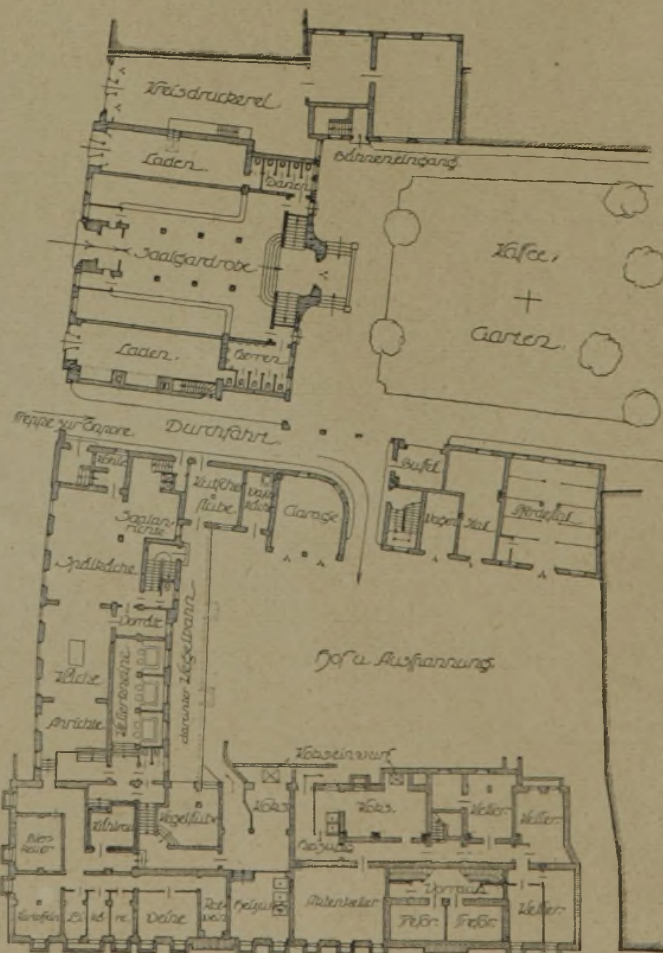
Grundriß Untergeschoß (rd. 1 : 600).
